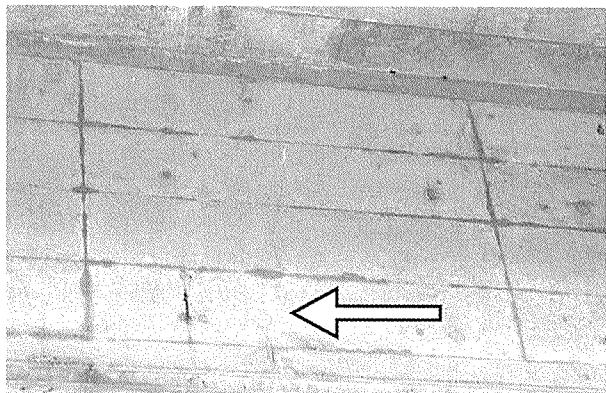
過大な荷重積載またはプレストレス不足によるひび割れ
